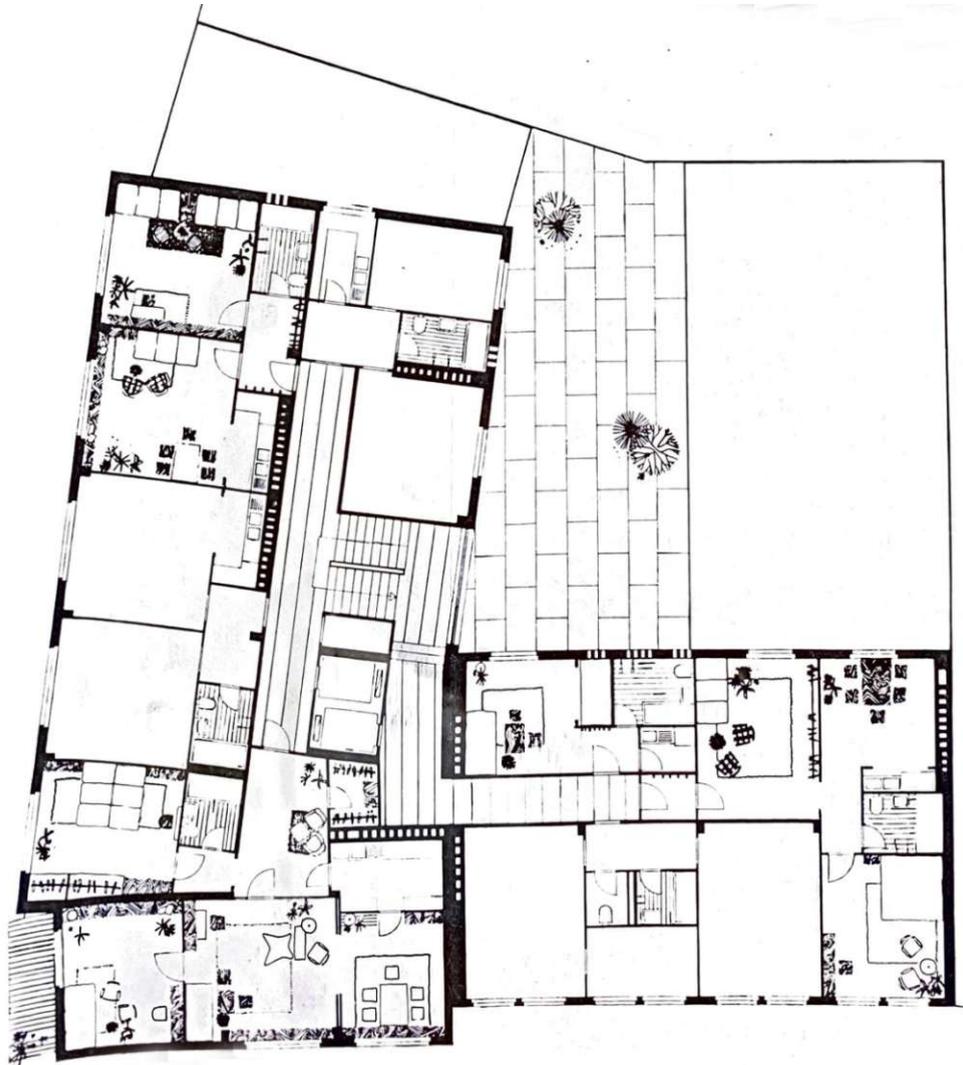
Artur Perotti, Ederhochhaus Grundrissplan Regelgeschoß, 1956.
